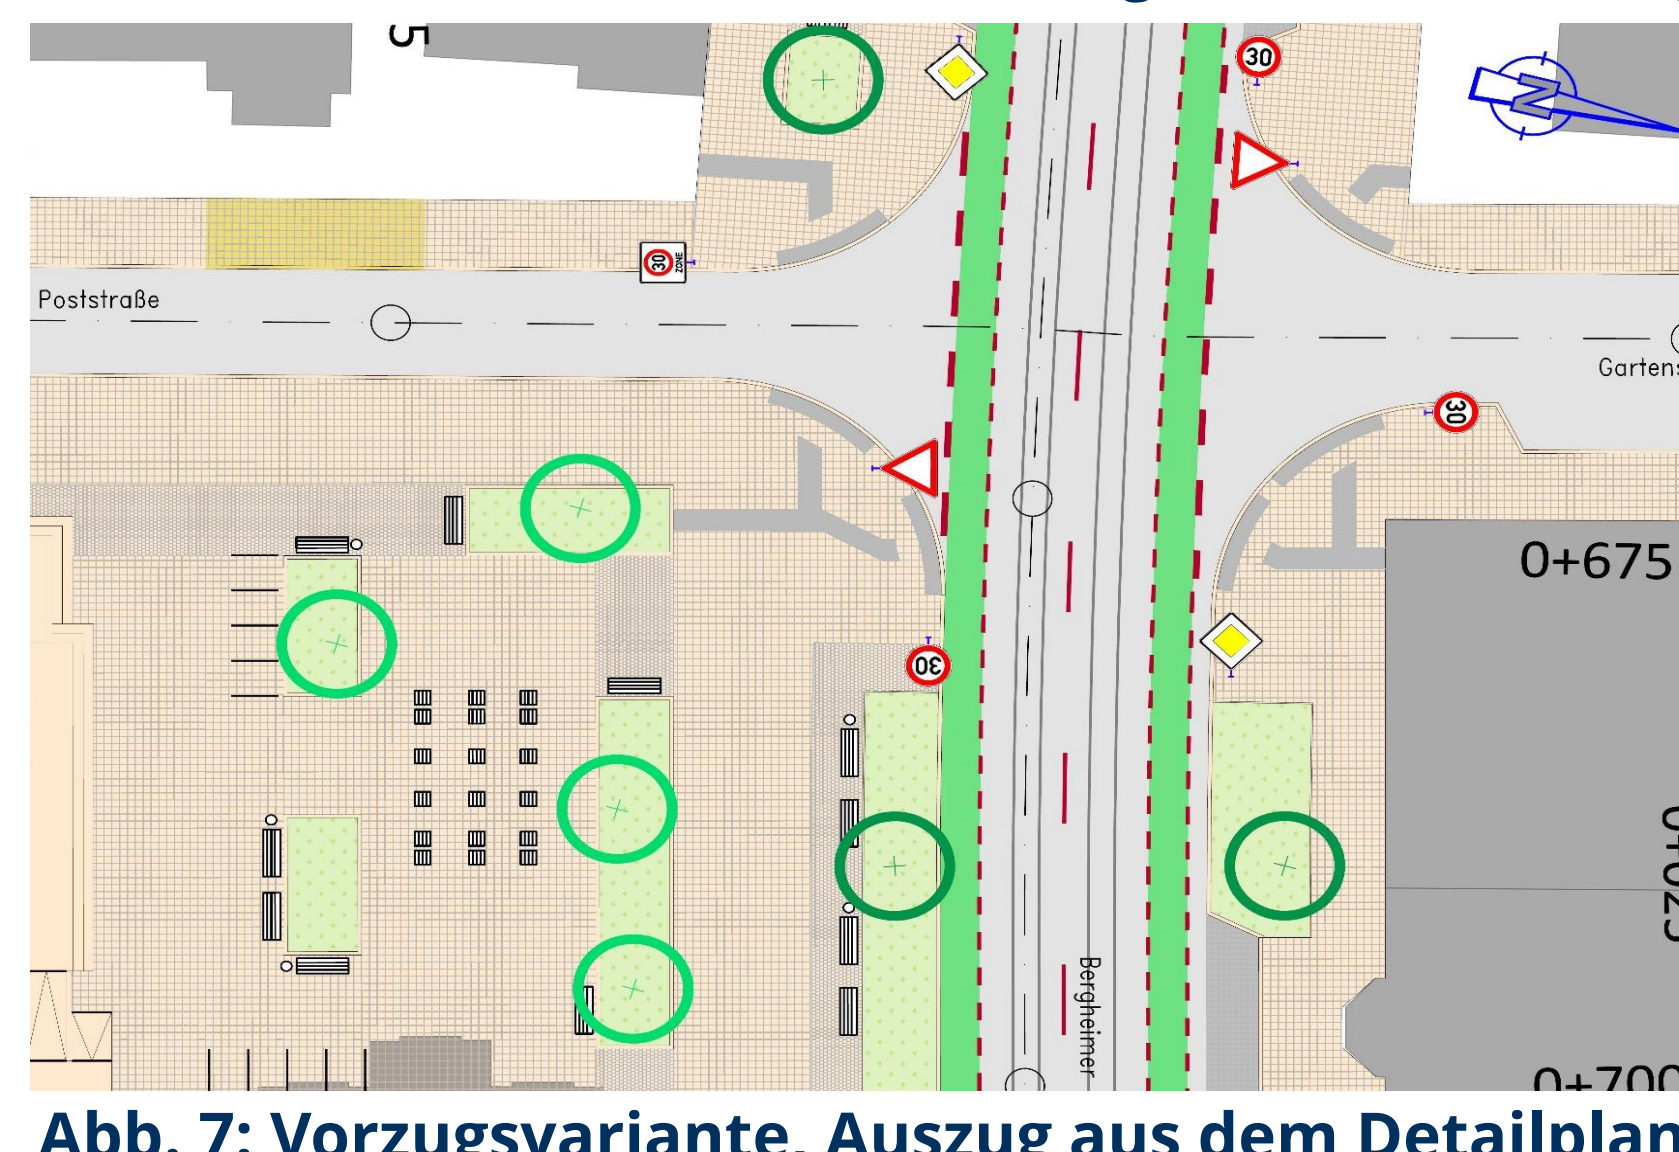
Vorzugsvariante, Auszug aus dem Detailplan
